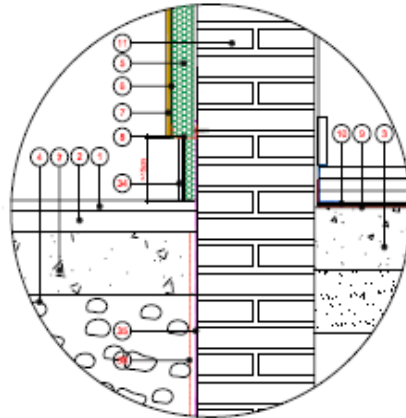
Detalle aislamiento térmico en solera. Fuente: propia
